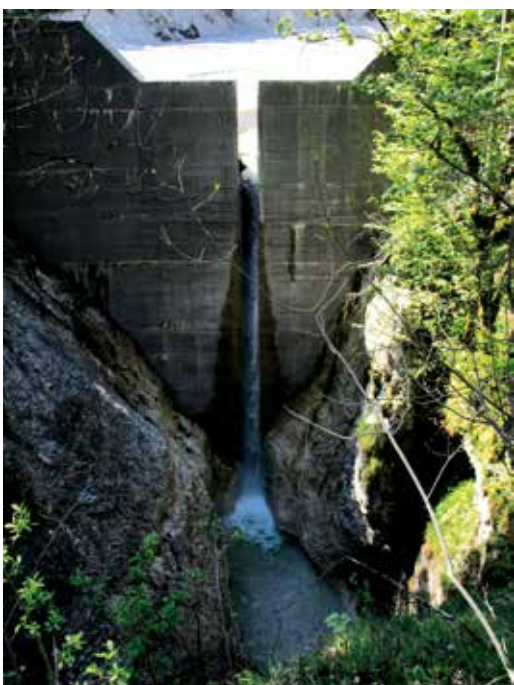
Schlitzsperre – hohe Verklausungsanfälligkeit infolge Wildholz und hoher Instandhaltungsaufwand 3: Schlitzsperre – hohe Verklausungsanfälligkeit infolge Wildholz und hoher Instandhaltungsaufwand
